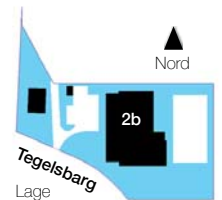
Variante 2 / Grundriss. Quelle: BIG
